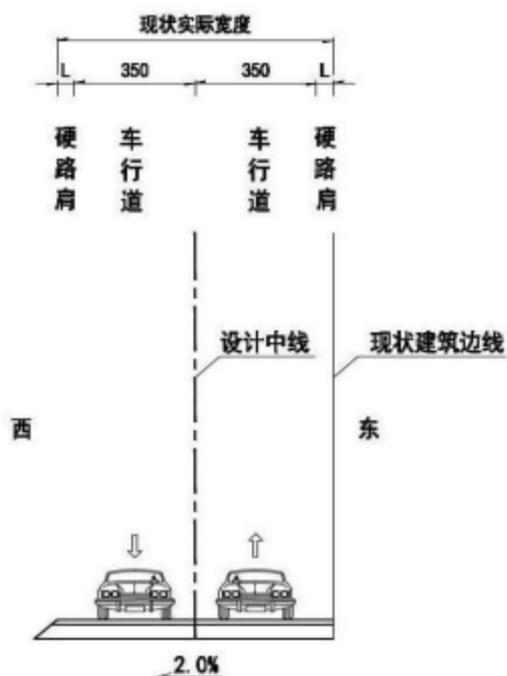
雅瑶小学门口道路标准横断面布置图
